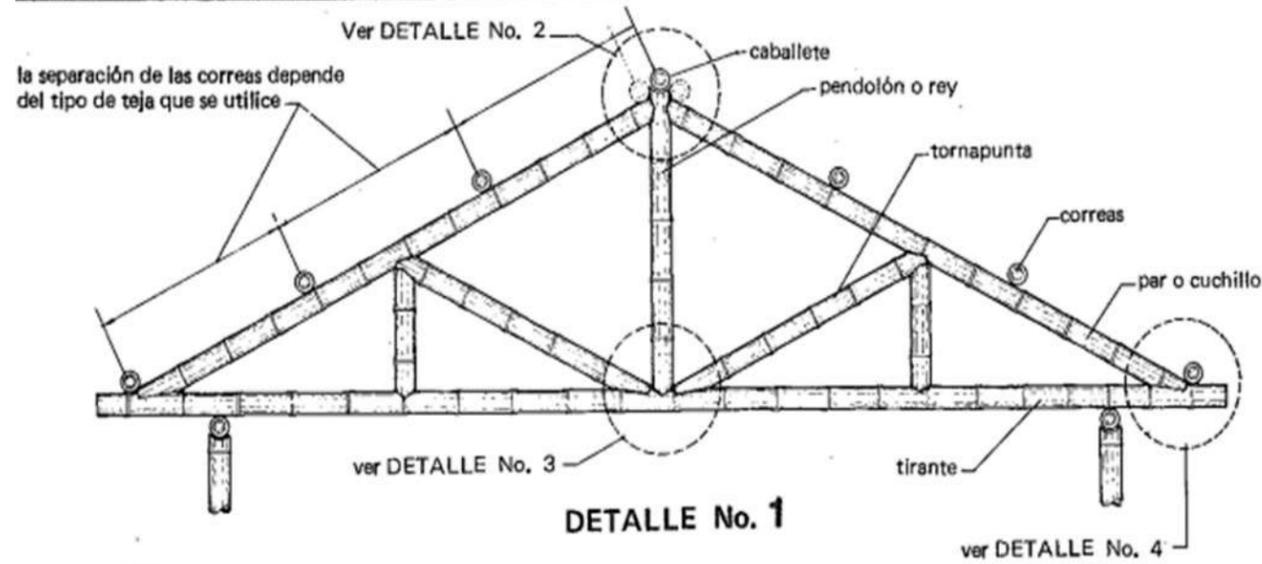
Detalle de cerchas. Fuente. Manual del bambú.
